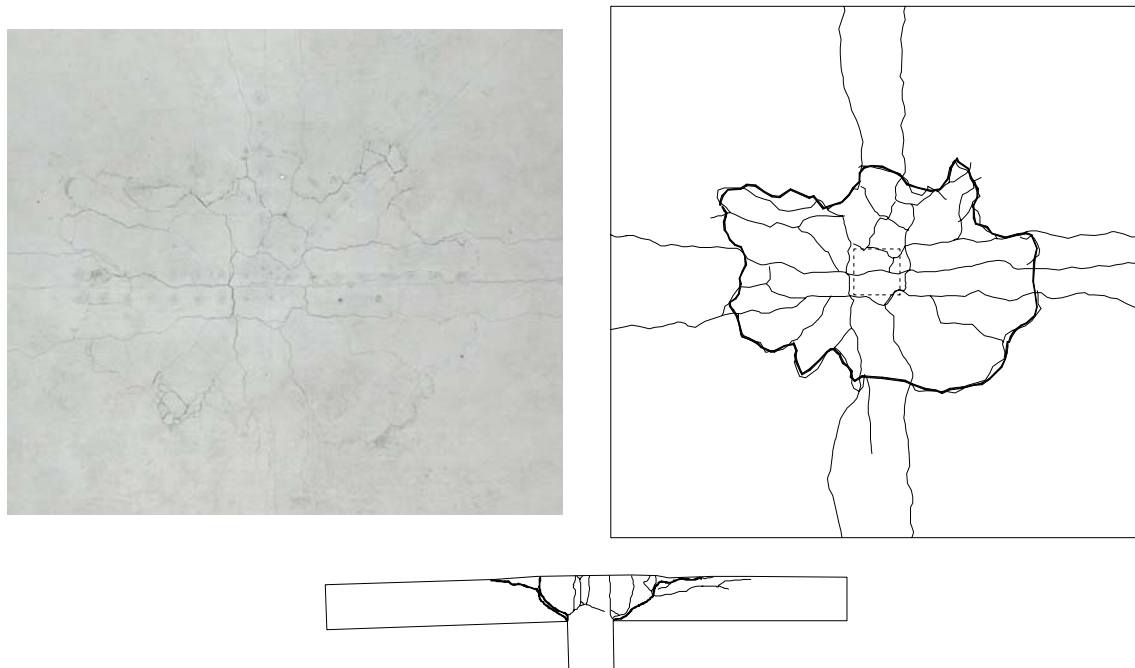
PG-4 : Fissures face supérieure (N en haut) et coupe NS
